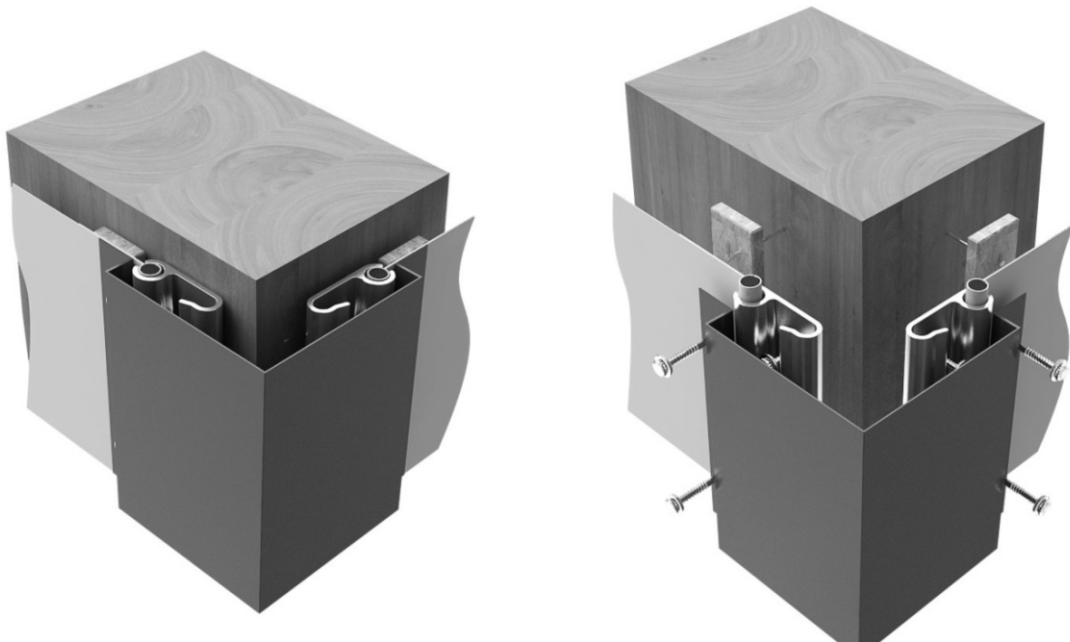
Fixation type 4 – coupe horizontale sur poteau intermédiaire
